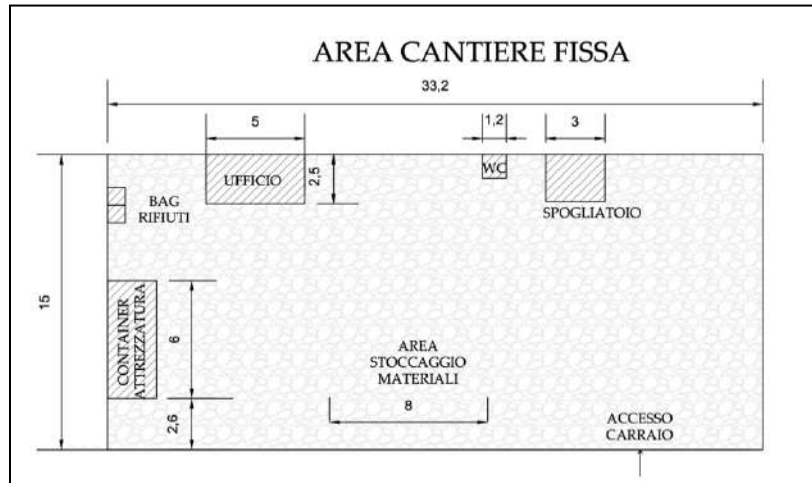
Particolare di un tipico di disegno da cantiere fisso
